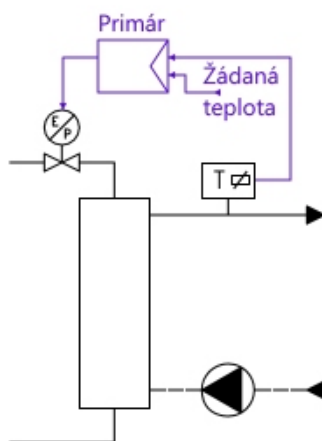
VZT ROBATHERM, zjednodušený přehled základních regulačních vazeb
